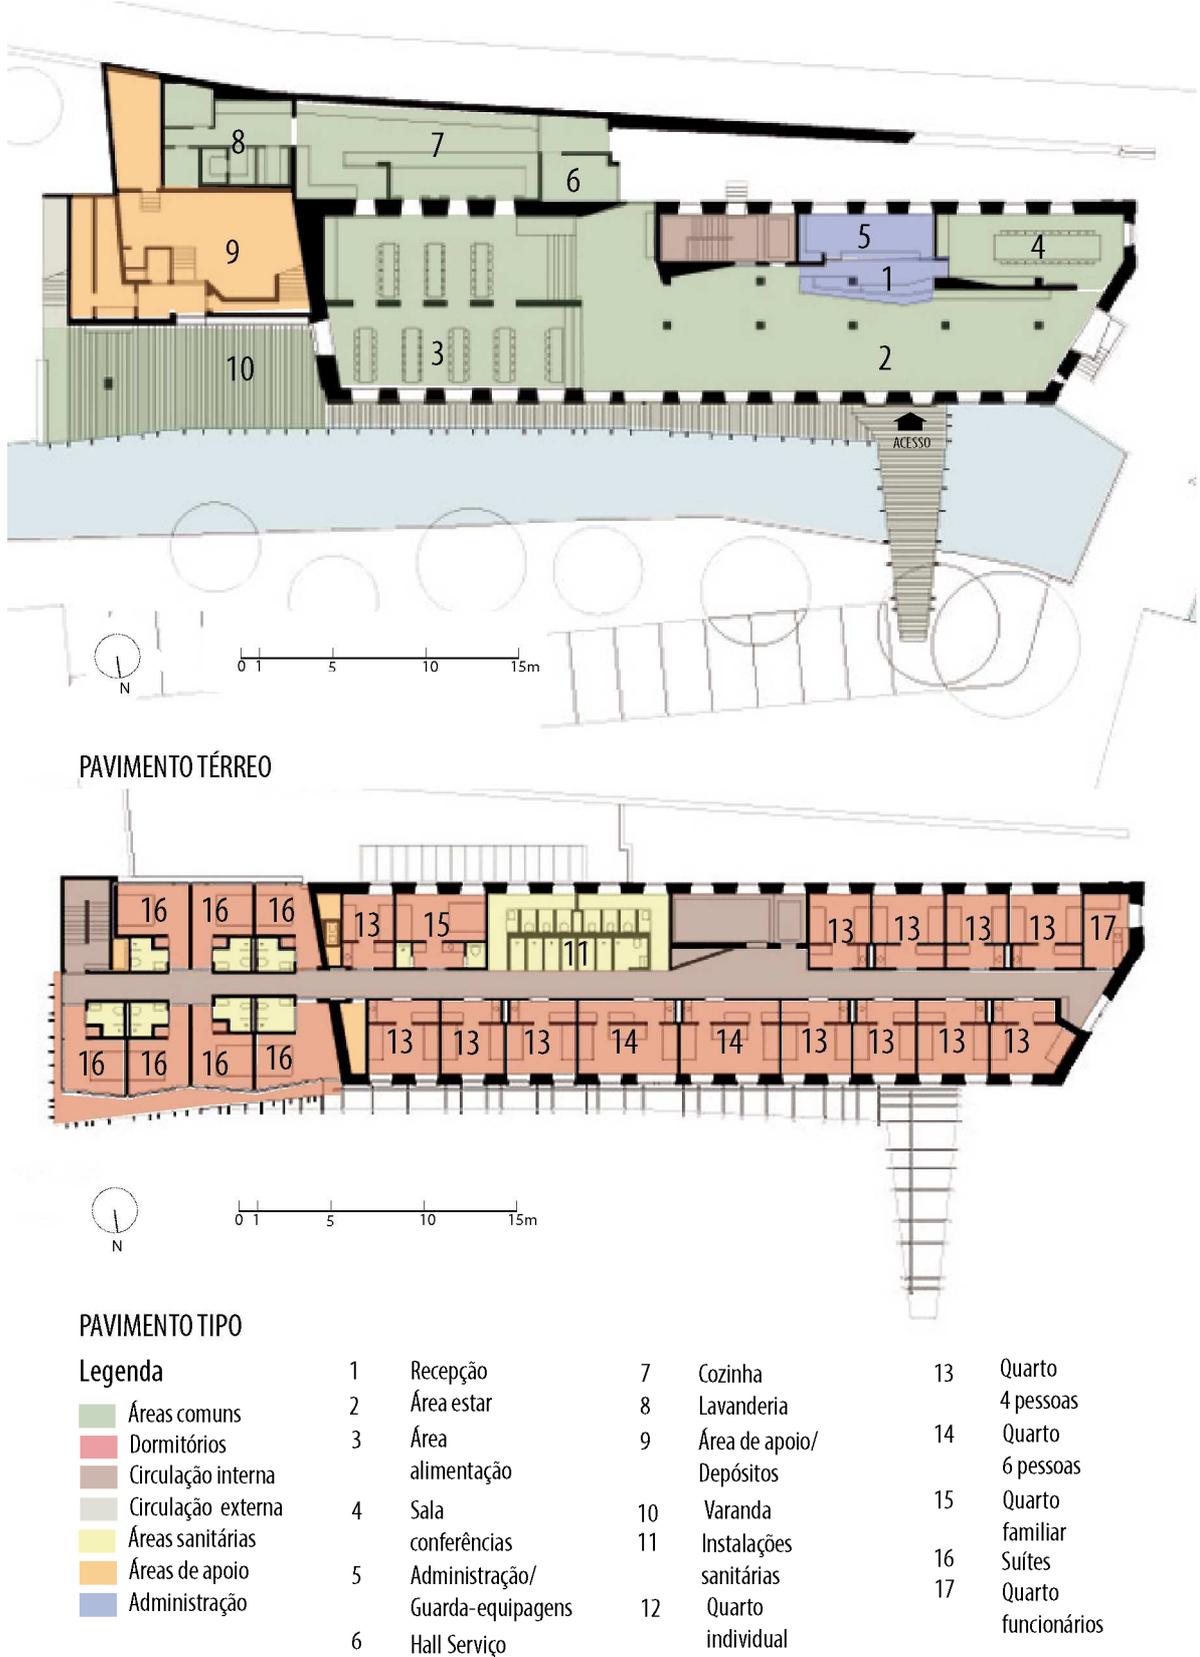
Plantas do pavimento térreo e pavimento tipo
